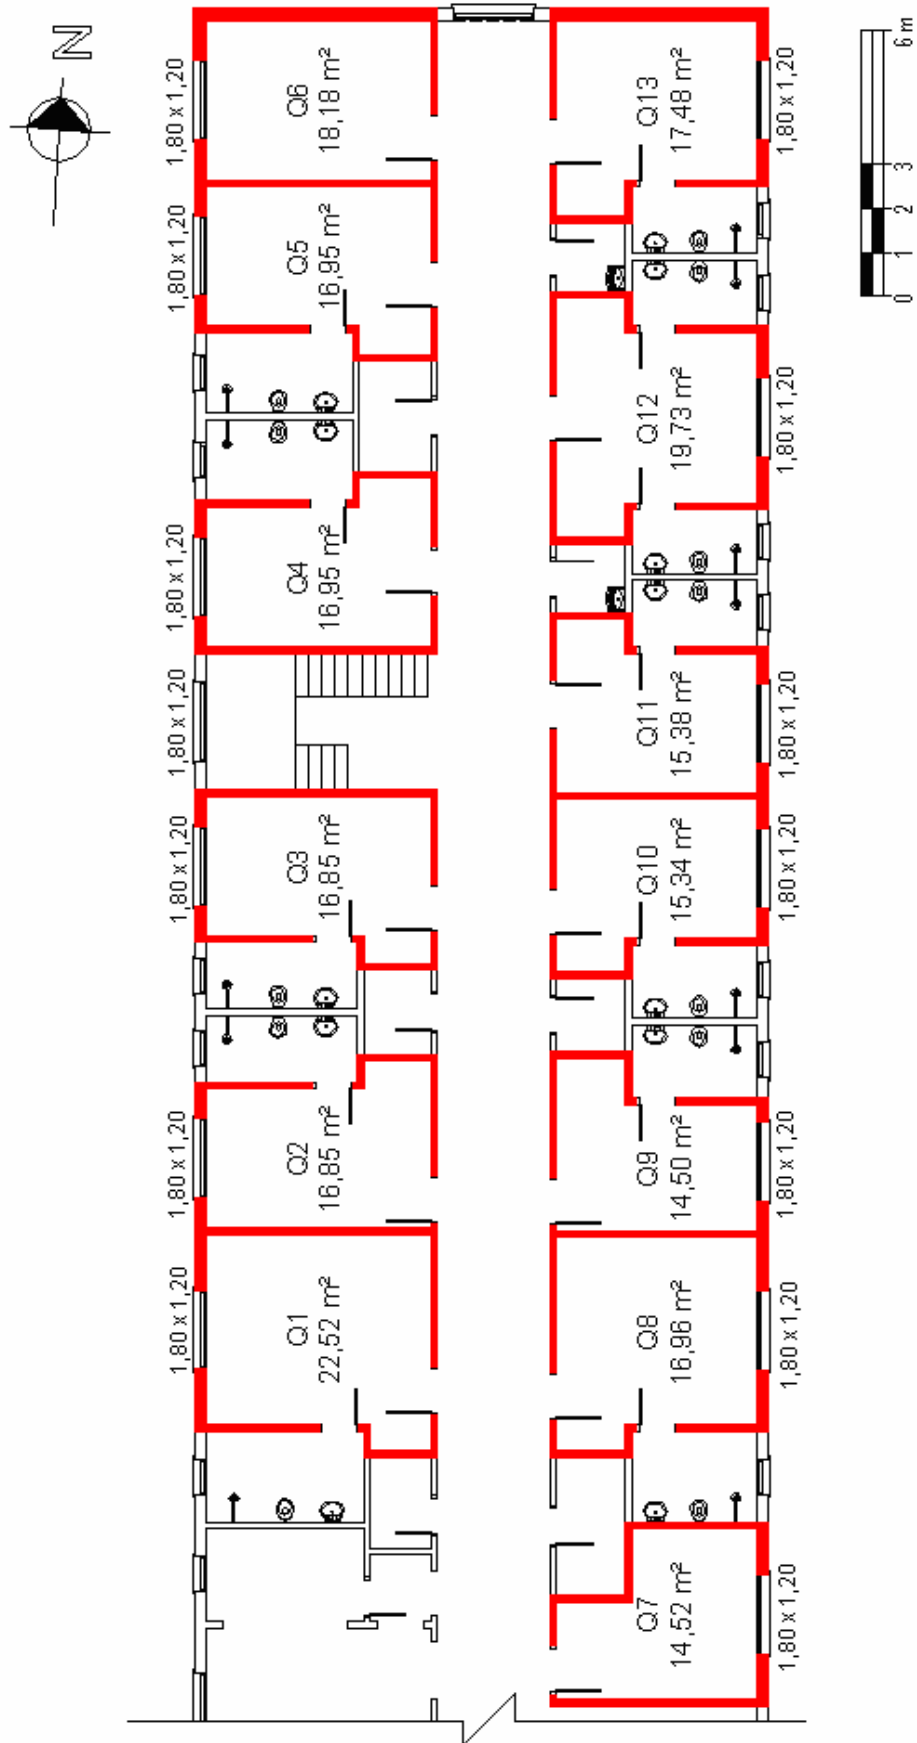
Planta baixa da área analisada do Hospital Bruno Born
